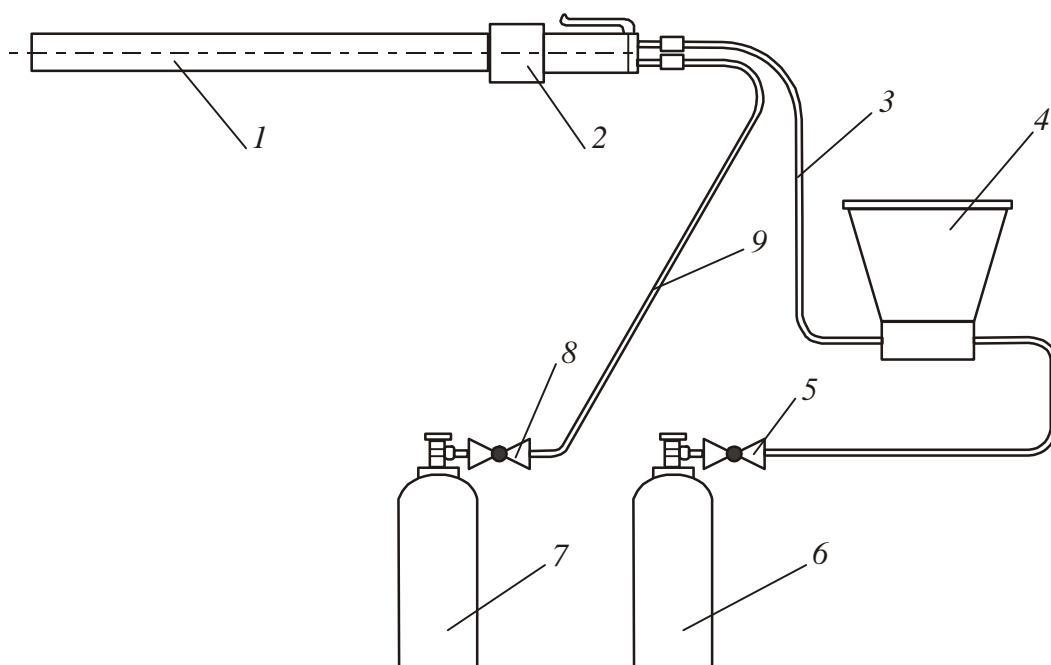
Прожигание отверстий в конструкции с помощью порошковой трубки: 1 – порошковая трубка; 2 – рукоятка трубки; 3 – бронированный шланг; 4 – смеситель порошка; 5 – воздушный редуктор; 6 – сжатый воздух; 7 – кислород; 8 – кислородный редуктор; 9 – шланг для подачи кислорода
